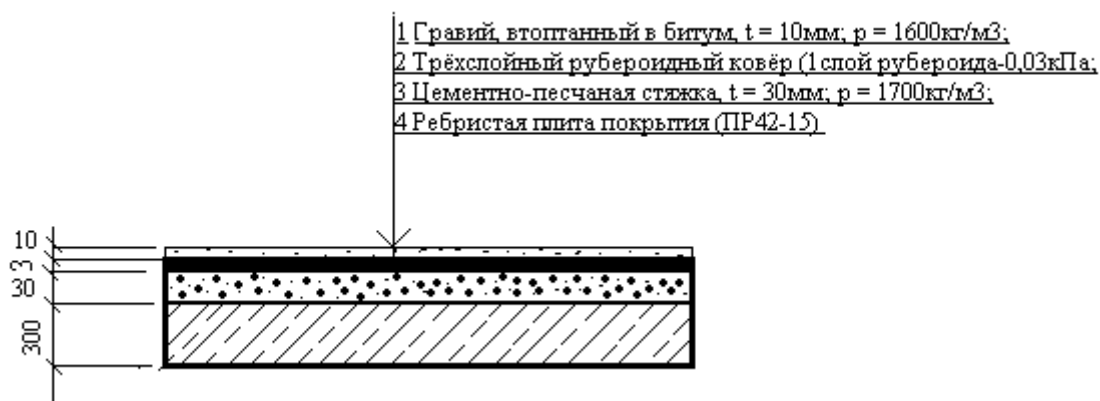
Многослойная конструкция для расчета нагрузки на ребристую плиту перекрытия
